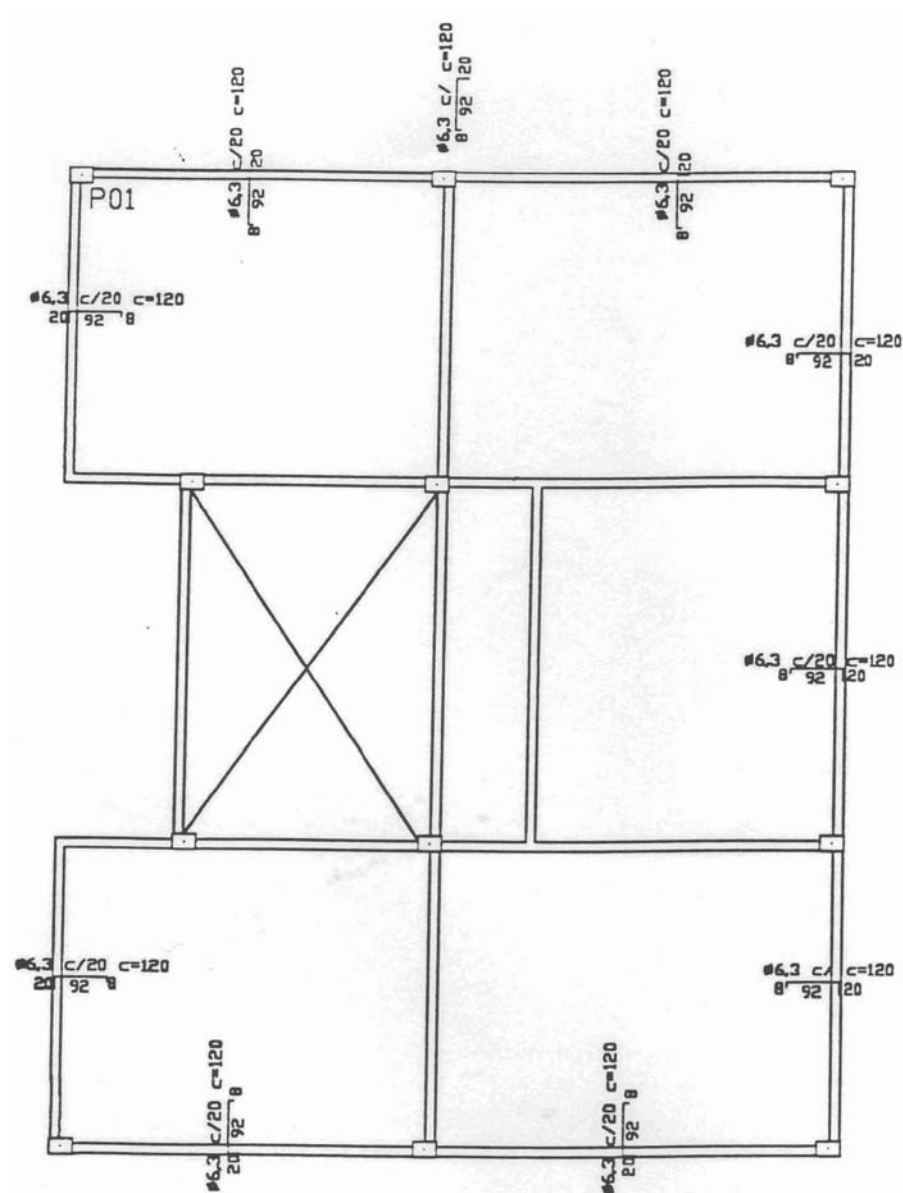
Detalhe de armadura negativa da laje do pavimento-tipo
